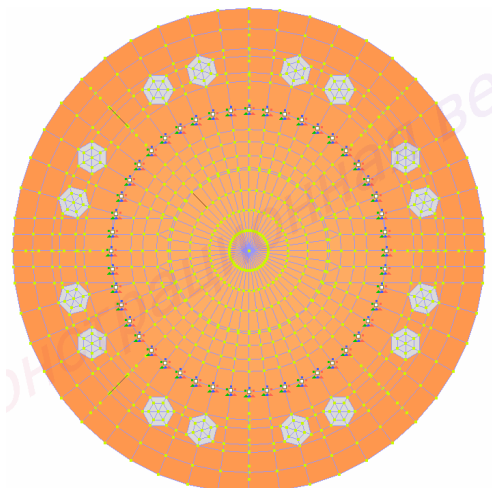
Просторова розрахункова схема головного вузла консольного колеса огляду – вузла лафети, ізометричний вид
